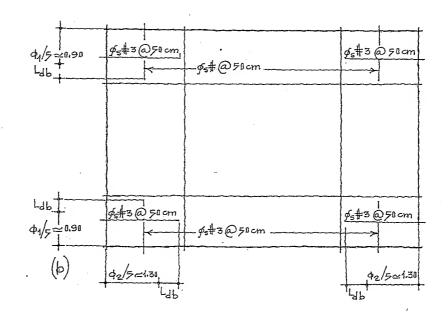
Planta de la los a mostrando los armados en ambos sentidos, (4).
